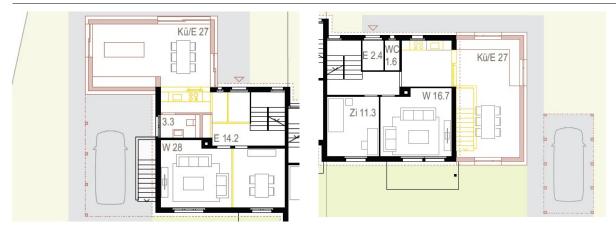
Zulässige Anordnung eingeschossiger Anbau um Gebäudeeck, Grundstück nördlich Mittelholzerweg
